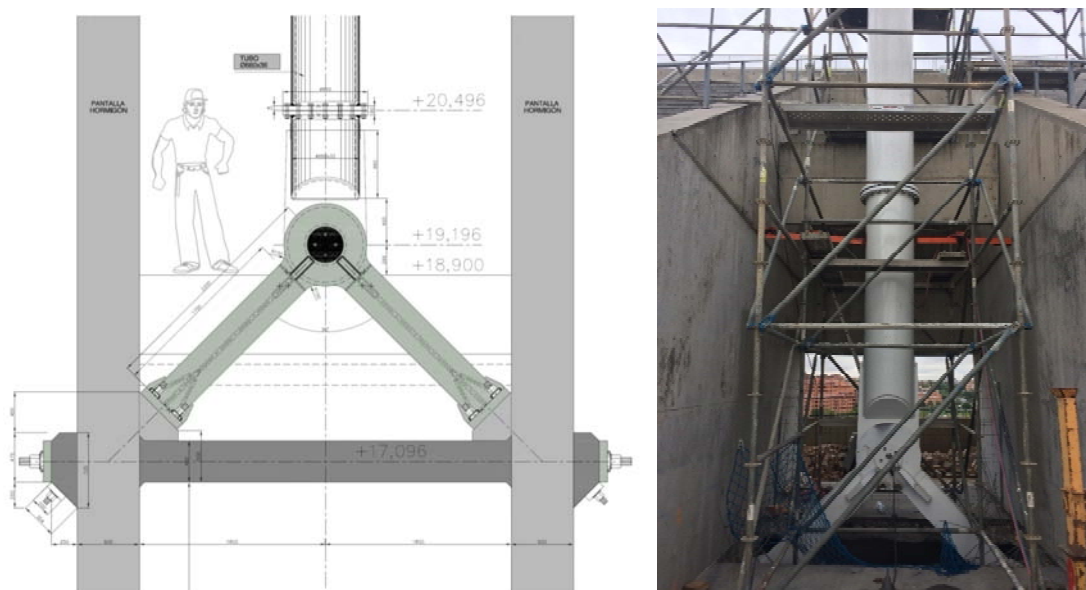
Apoyos de la cubierta en los pórticos de la tribuna existente
